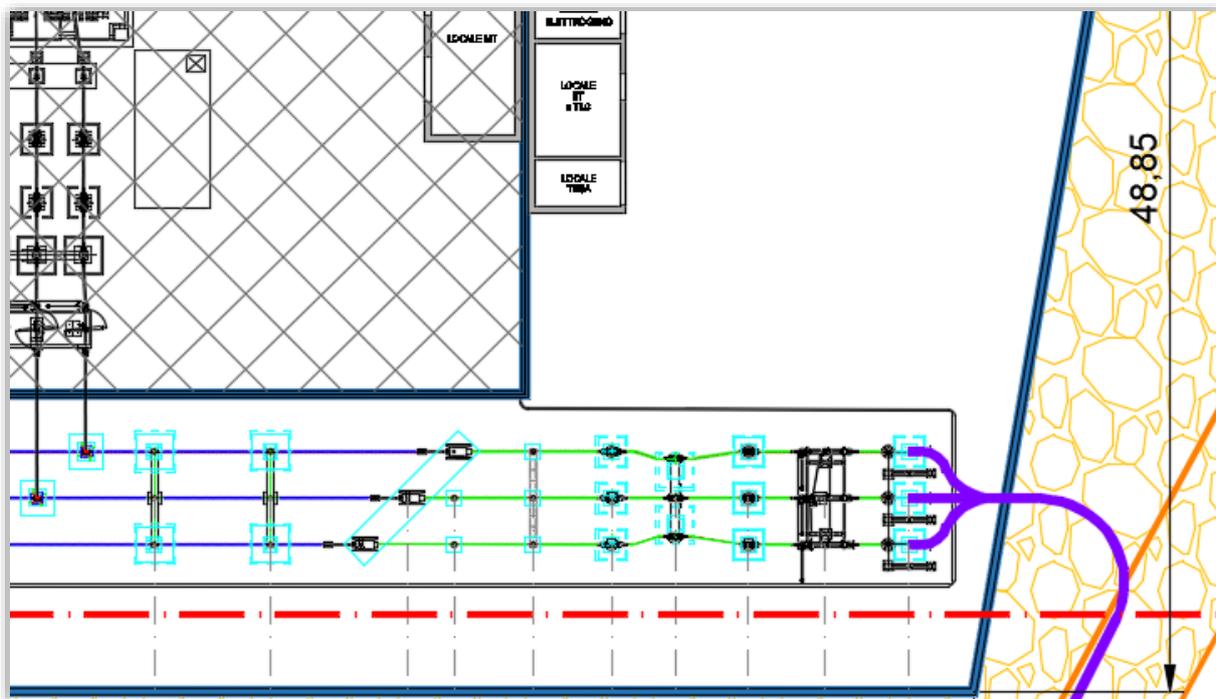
Planimetria elettromeccanica dello Stallo di Arrivo nell'Area Comune.
